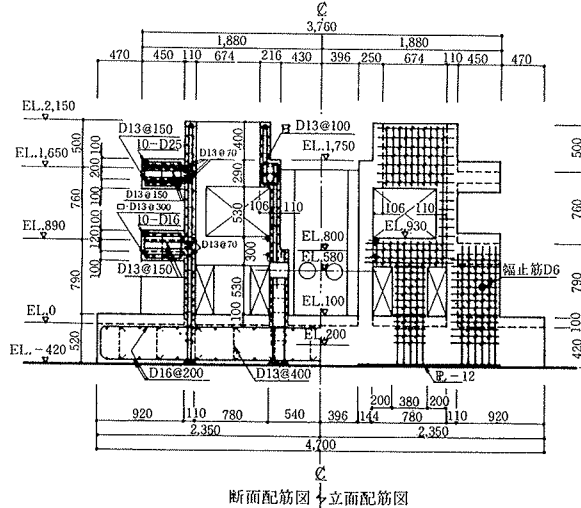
試験体 Y-Y 断面および配筋図<sup>1)</sup>
